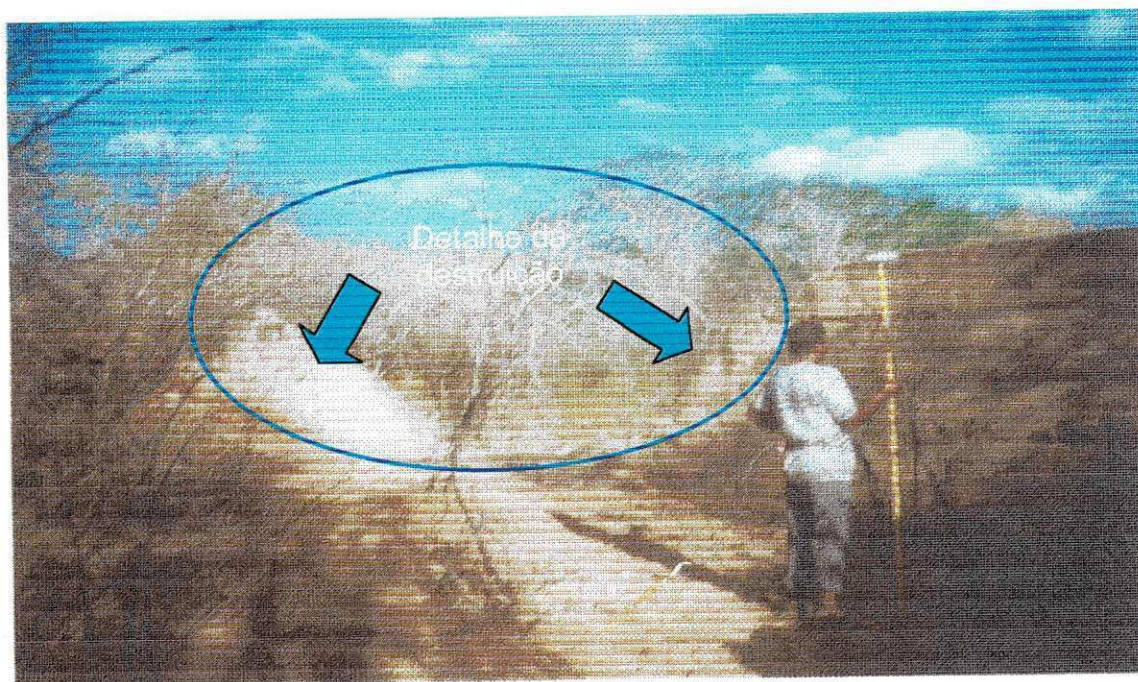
Barramento do Riacho Urubu ou Pedras Pretas
